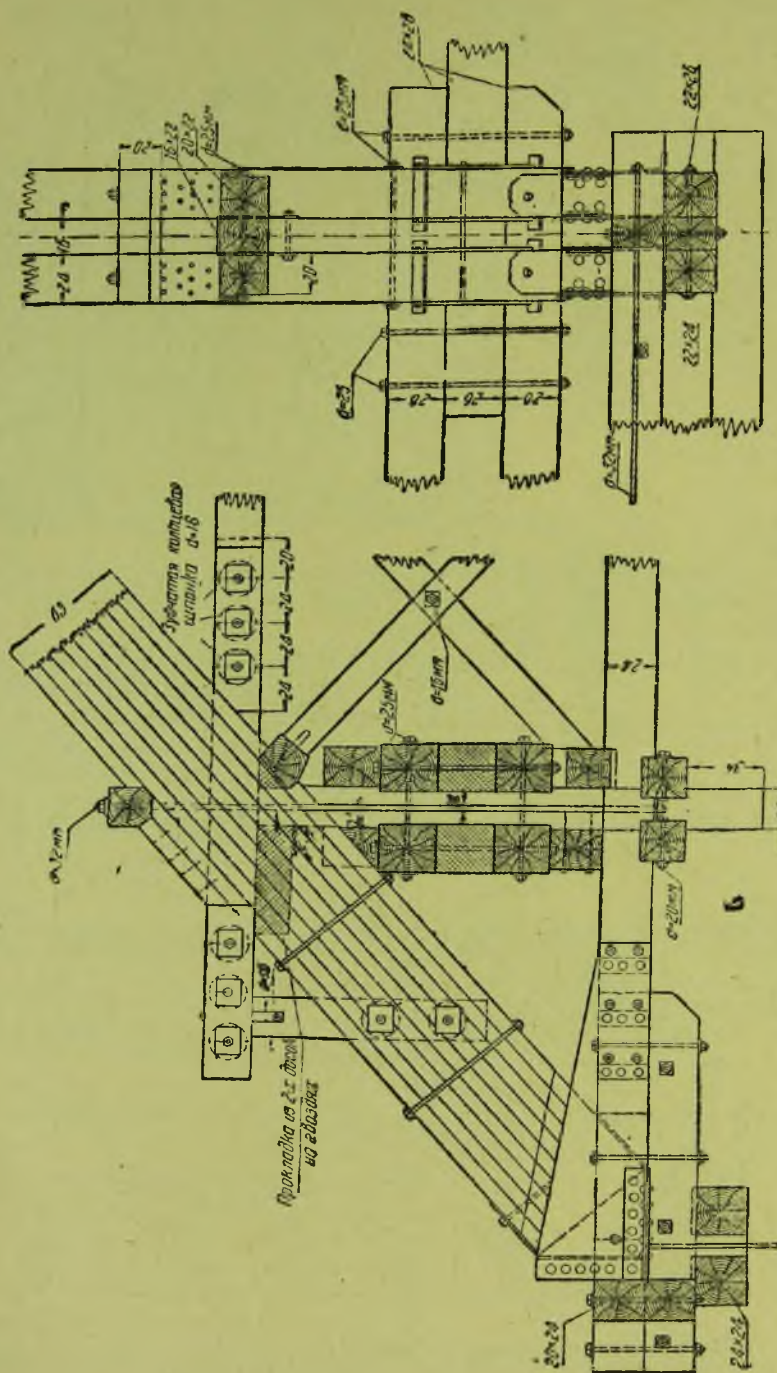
Деталь сопряжения подвесок с аркой фермы Лангера.
